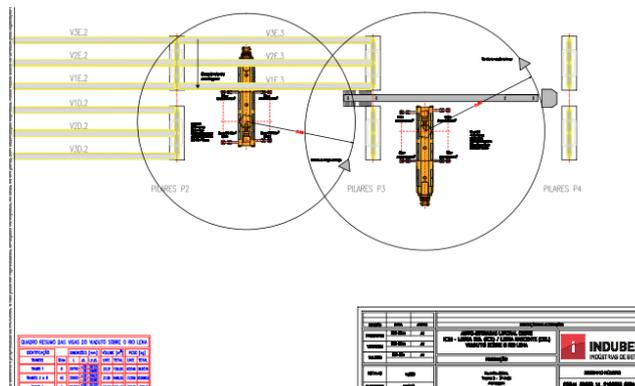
Exemplo peças desenhadas do plano de montagem. (INDUBEL, S.A)
